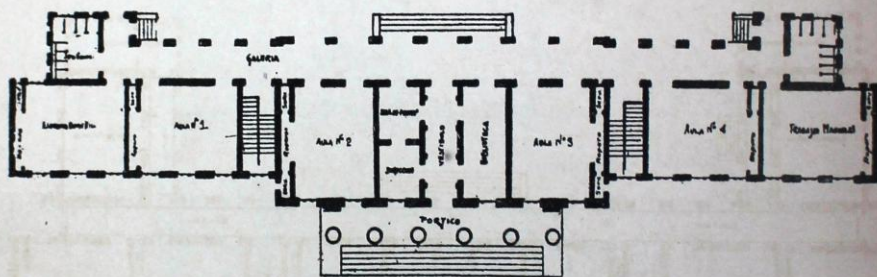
Plano de edificio para centro escolar. Tipo B. Planta baja.
